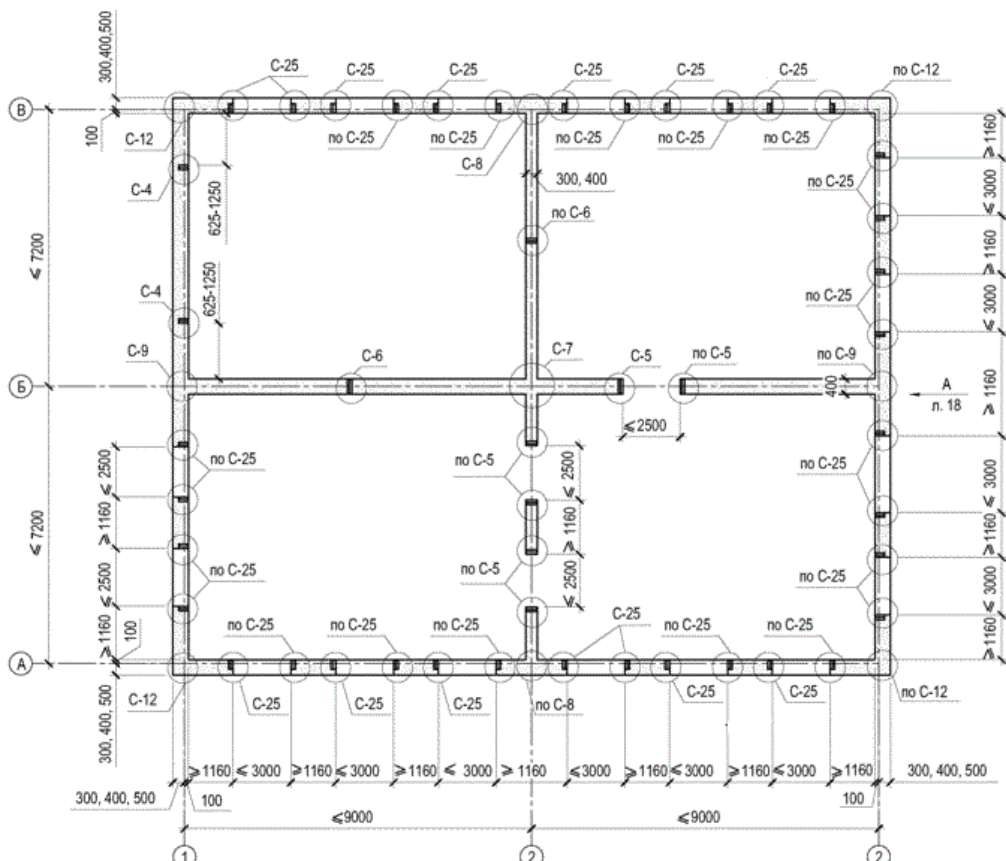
Схема размещения монолитных сердечников при возведении стен из пенобетонных блоков
